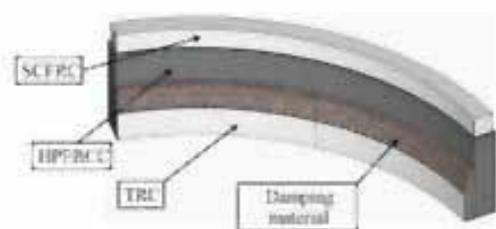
Schema del cono di tunnel realizzato con calcestruzzi fibrorinforzati (SCFRC e HPFRCC) per la parte strutturale e con uno schermo protettivo in collapsibile concrete, rivestito di una calotta in Textile Reinforced Concrete
